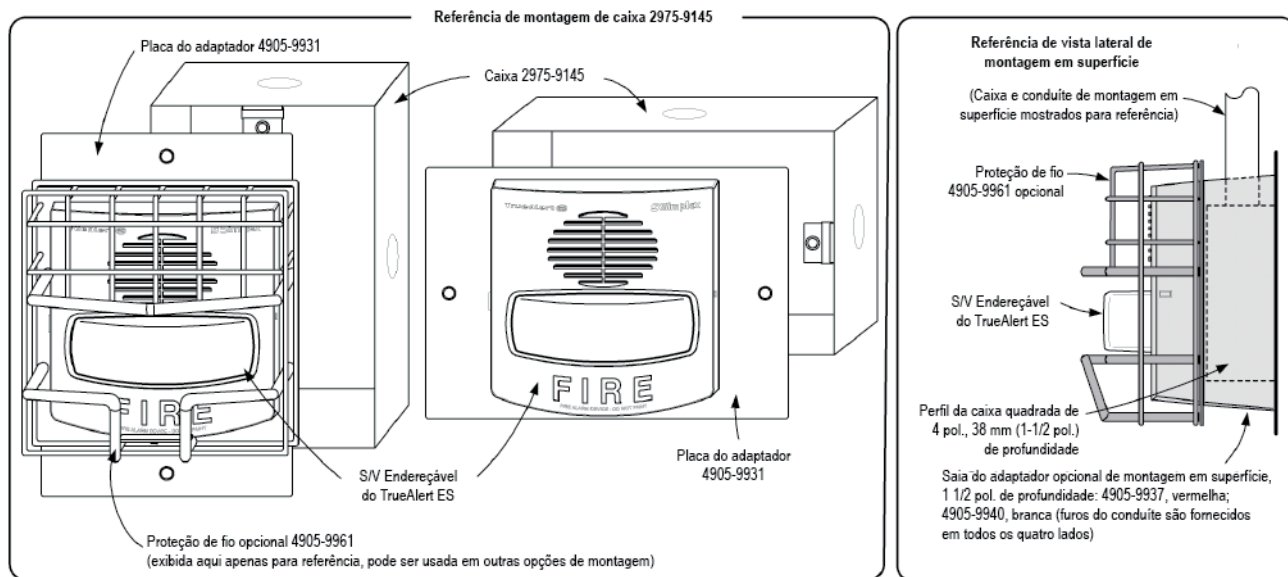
Referência de Instalação da Placa do Adaptador e Montagem de Superfície
